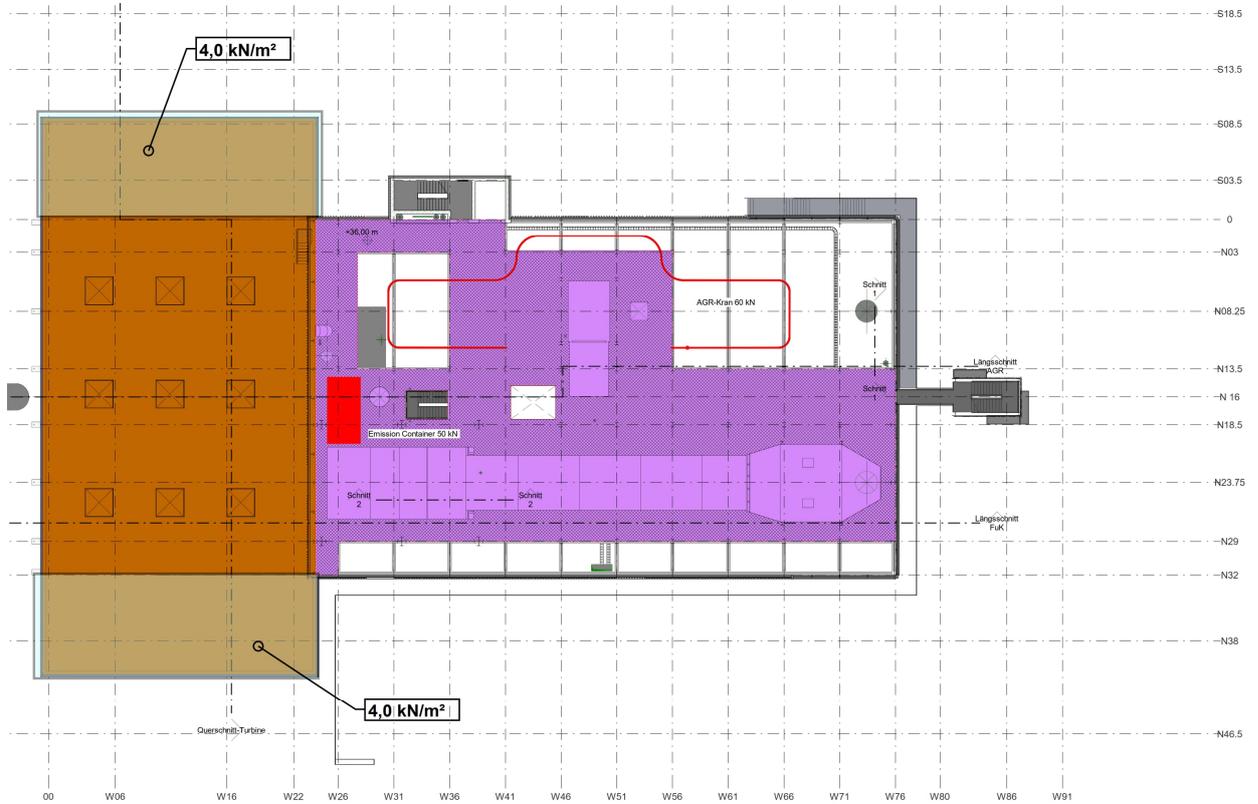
Nutzlasten Grundriss +36.00m
